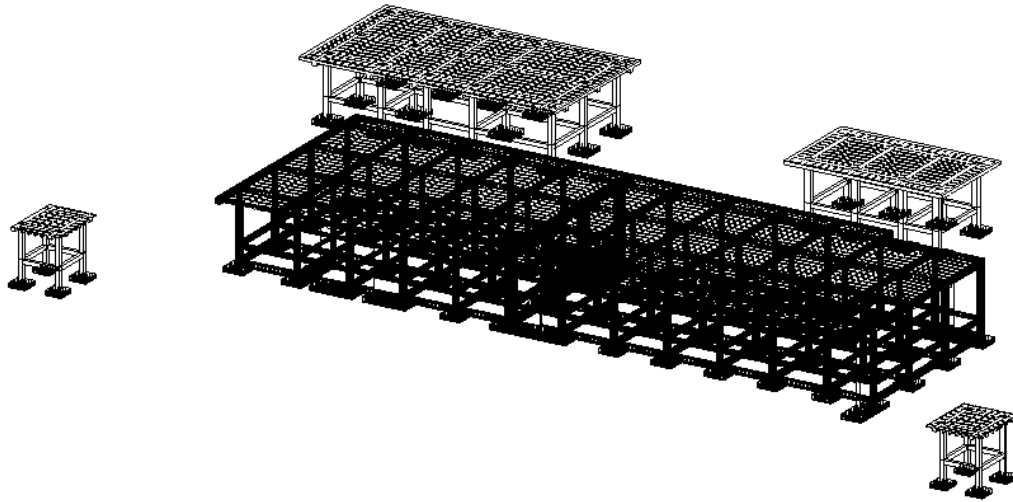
(Elaboración Propia) Modelado acero estructural.
